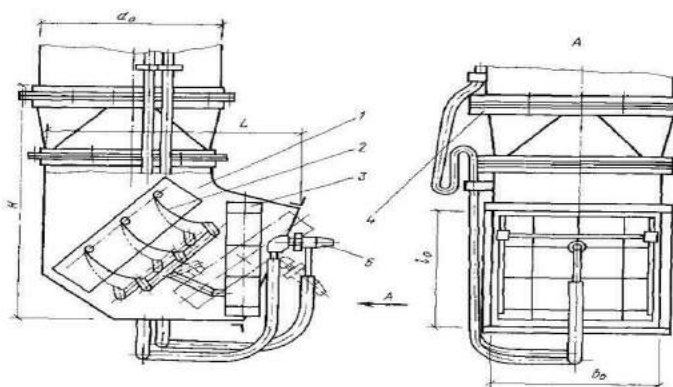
Универсальный душирующий воздухораспределитель с увлажнением воздуха и с верхним подводом воздуха. Условные обозначения: 1 – корпус; 2 – направляющие лопатки; 3 – направляющая решетка; 4 – шарнирное фланцевое соединение; 5 – пневматическая форсунка
